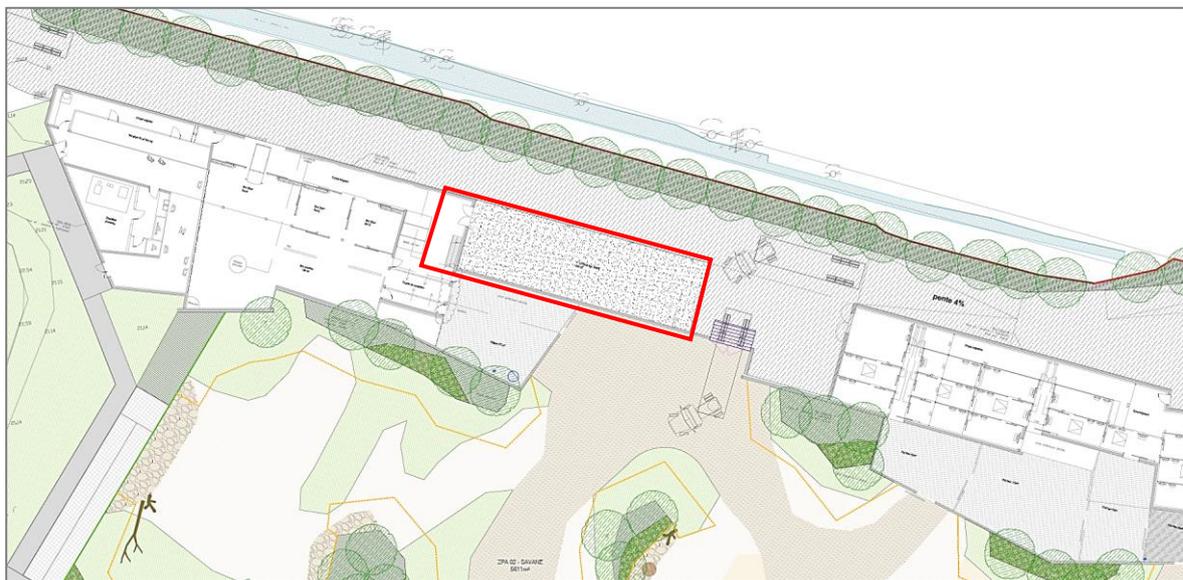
Plan de la zone de stockage du foin, de la paille et de la luzerne
